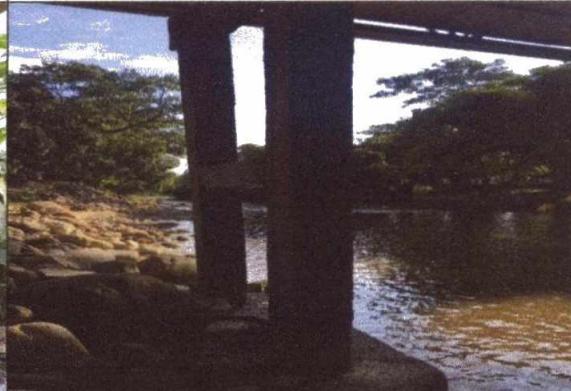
ESTRIBOS DE APOYO DEL PUENTE
